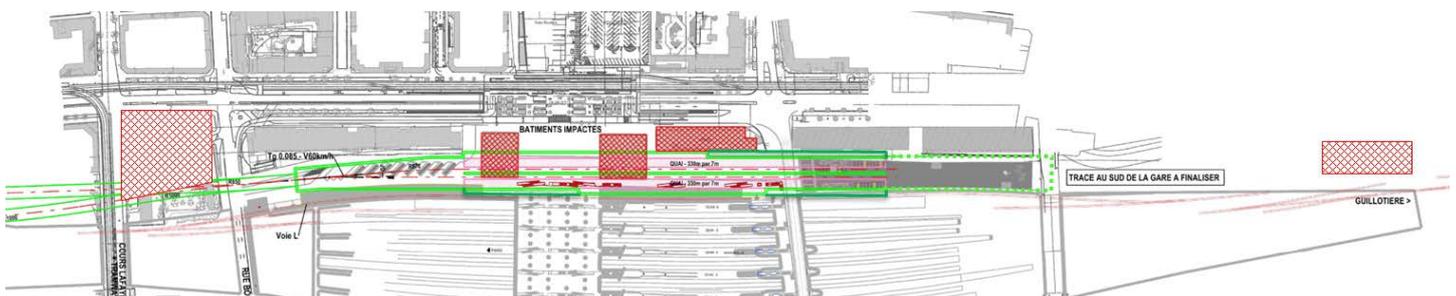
Solution 5 - schéma (en plan et coupe) de division des voies dans la boîte
